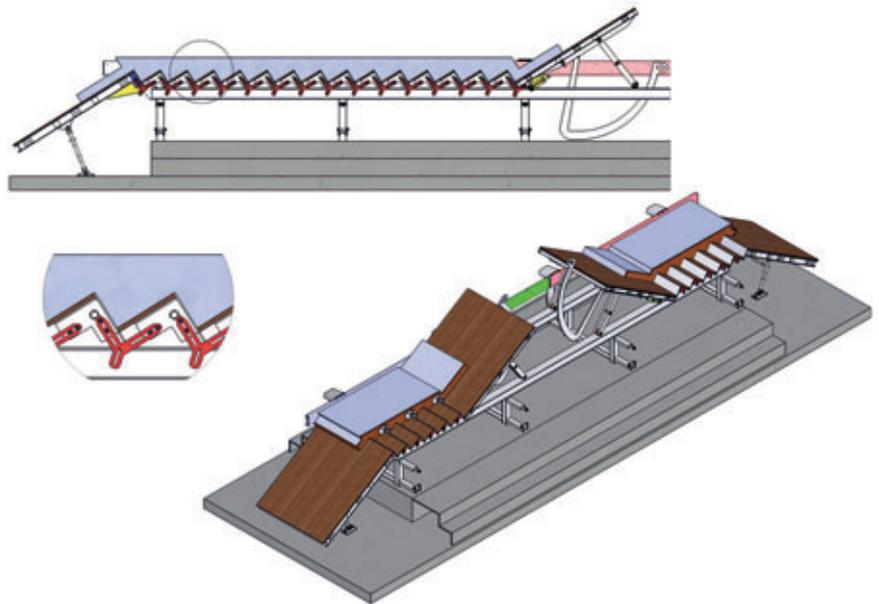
Encofrado de escaleras con rellano para hormigón visto (fabricación en negativo)
